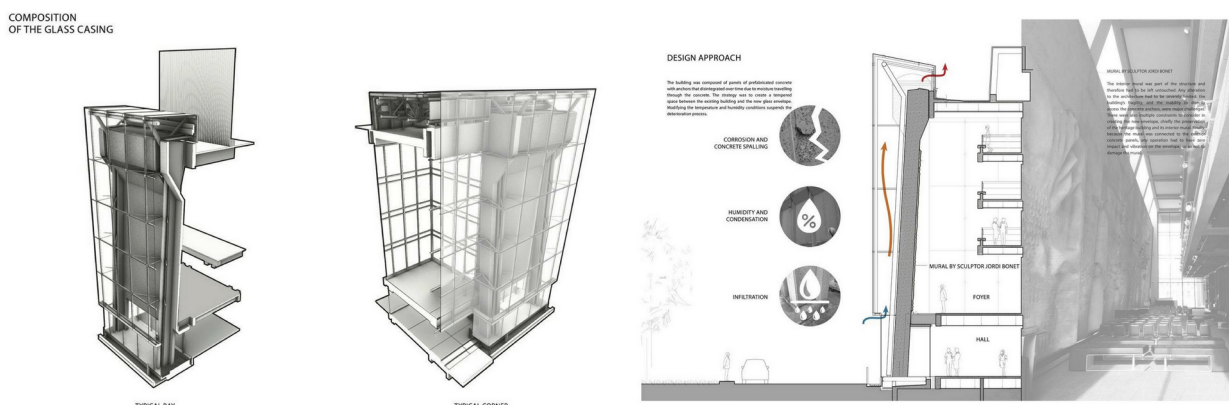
Конструктивна 3д схема фасаду.
